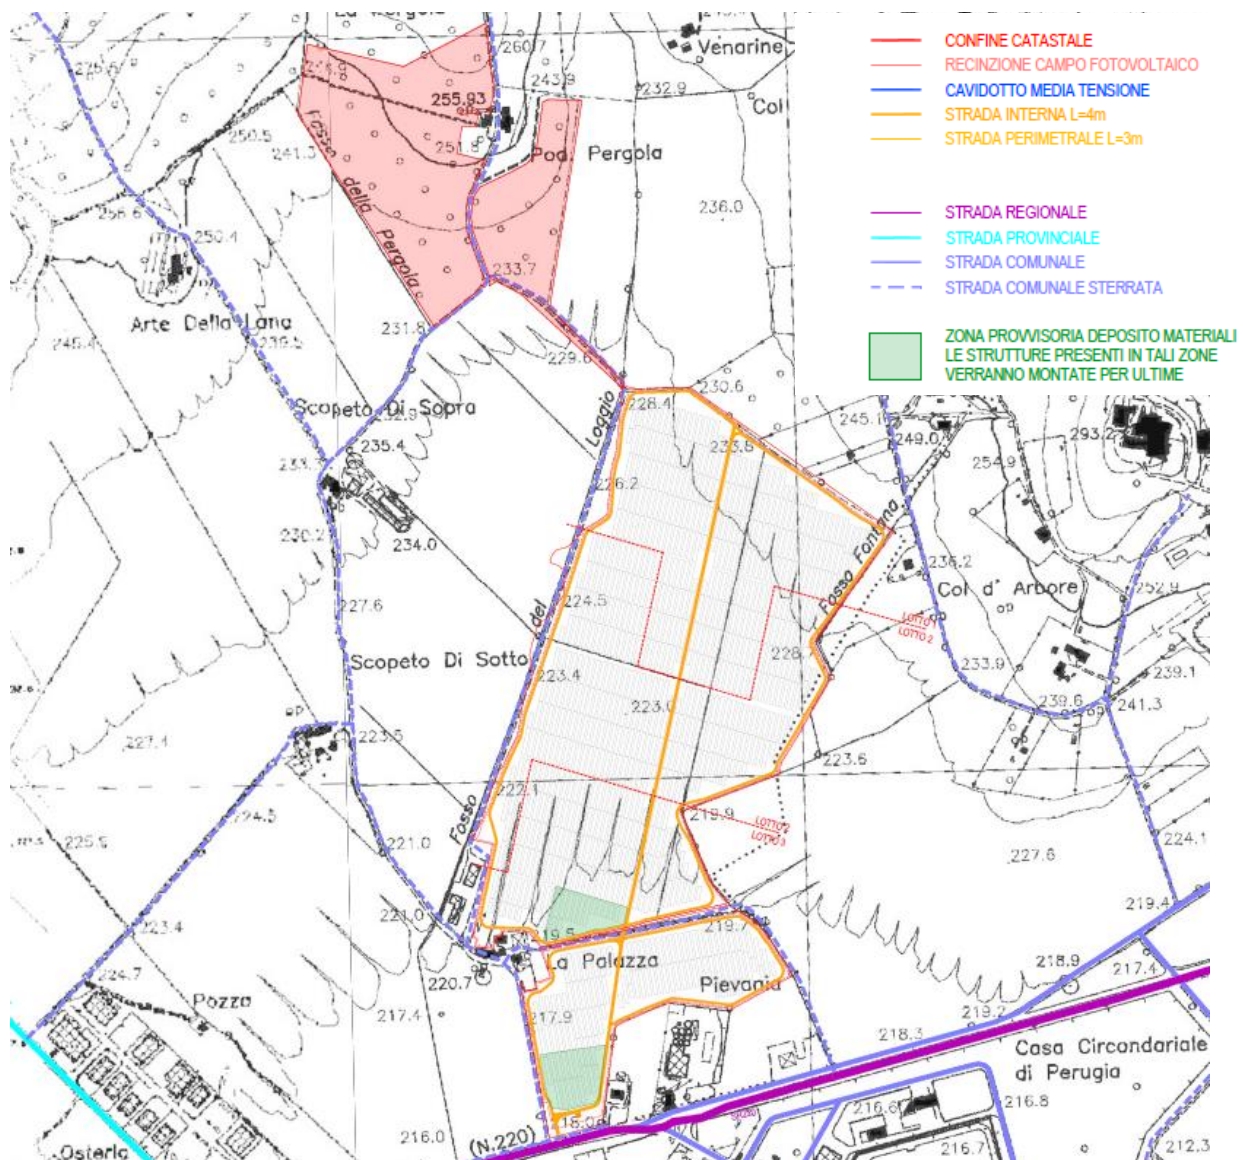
Ubicazione aree di cantiere dell'impianto
